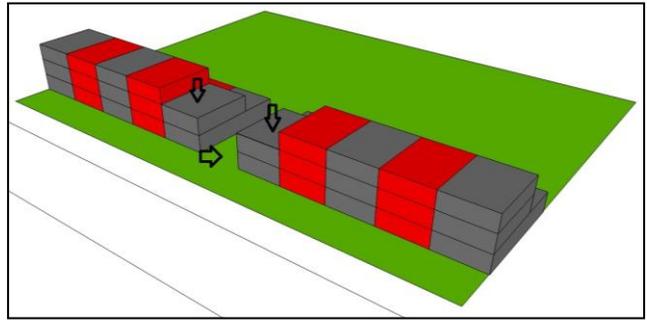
Ouverture centrale sur le mail piéton. Source : Auteur 2017.
